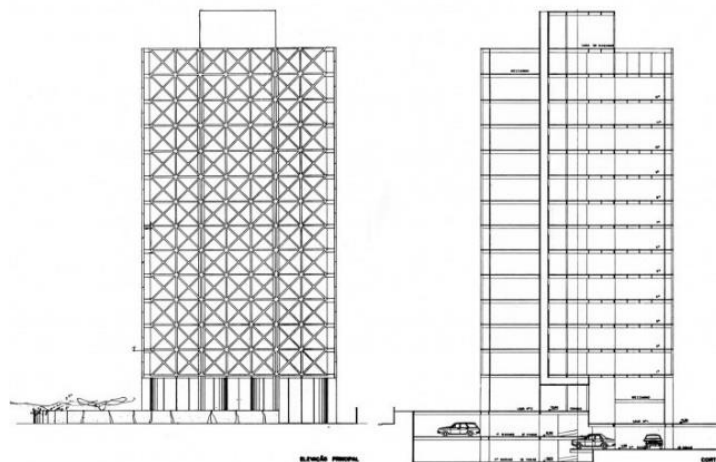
Elevação e corte, respectivamente, do Edifício Acal (Fonte: ESPALLARGAS, 2016)
